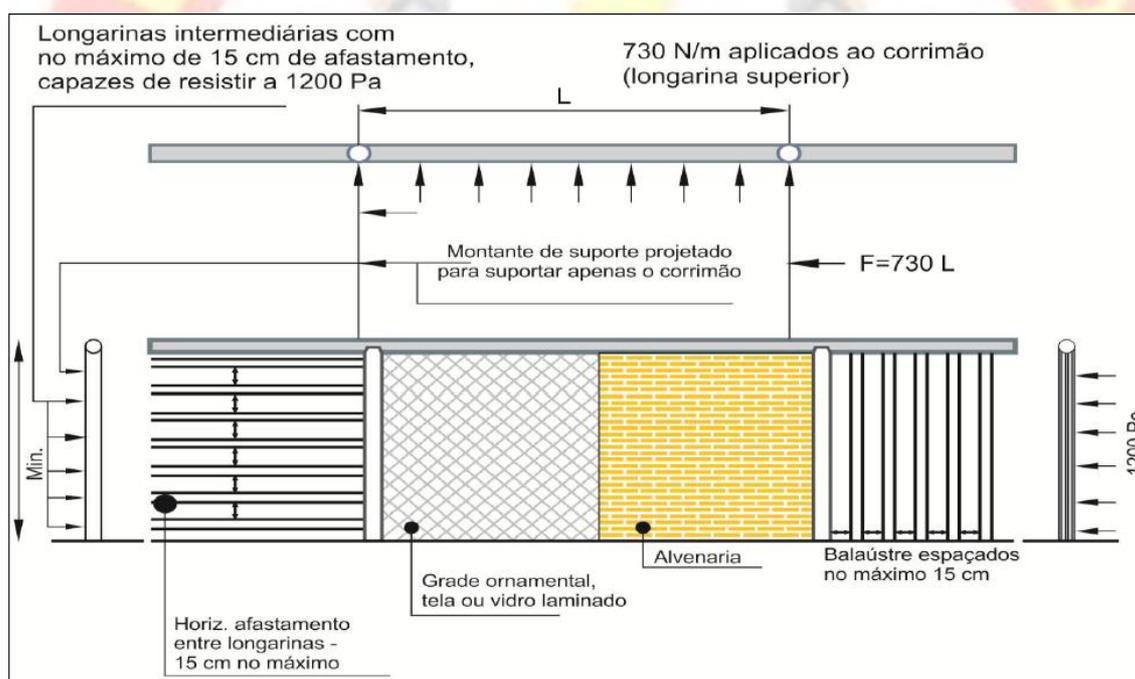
Pormenores construtivos da instalação de guardas e as cargas a que elas devem resistir
